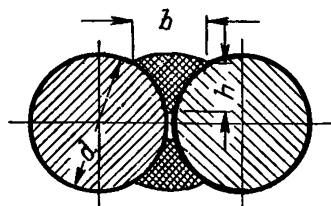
Размеры сварных фланговых швов при соединении гладких стержней и стержней периодического профиля
